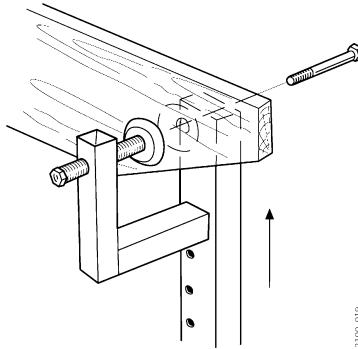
Platzierung der Hängeplattform-Zwingenbefestigung
